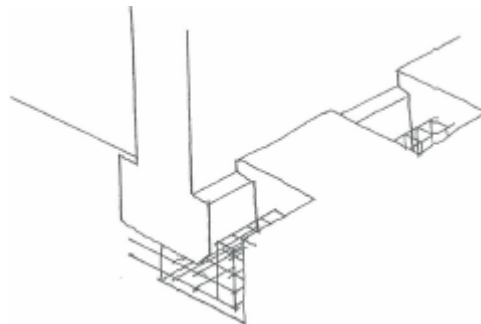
Execução da armadura nos troços escavados de um dos lados da fundação [55]
